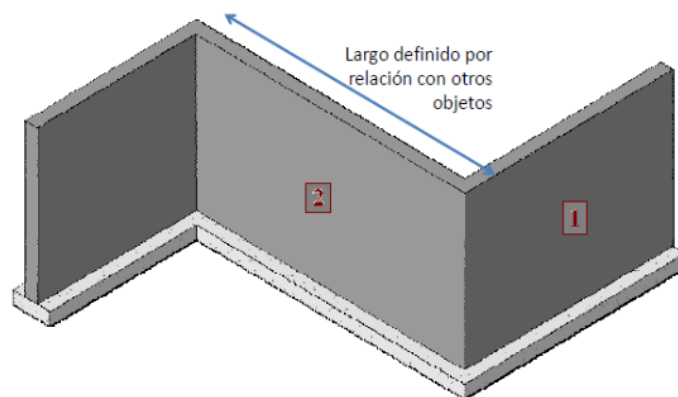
Si muevo el muro 1, automáticamente se modifica el largo del muro 2
